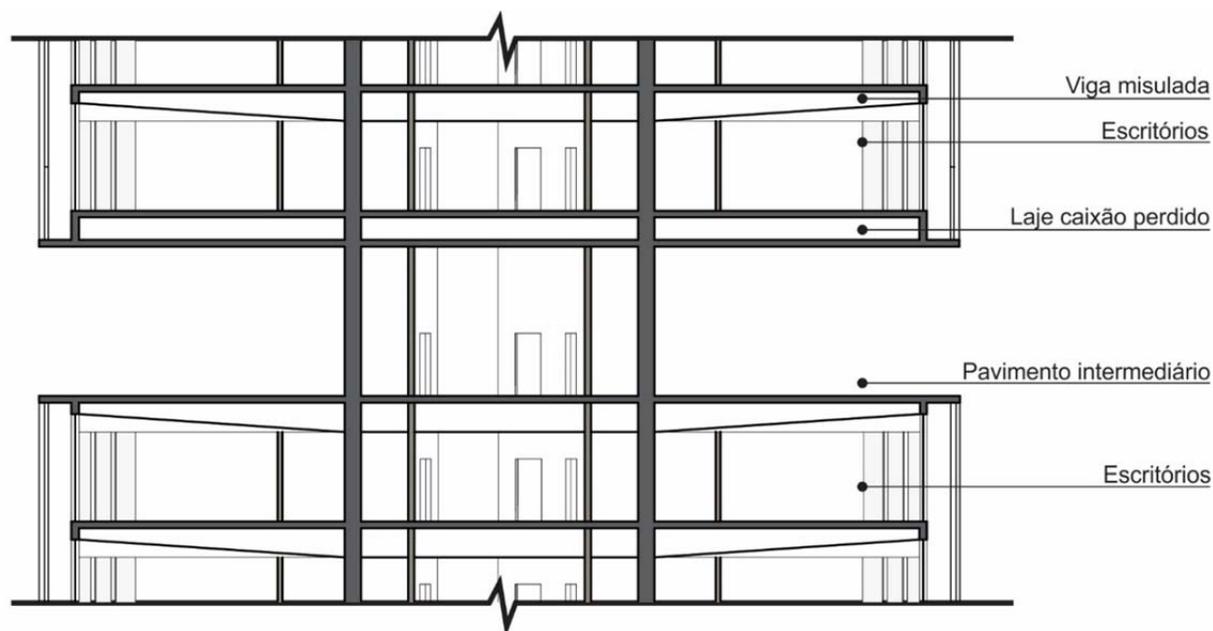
Corte estrutural passando pelo pavimento intermediário e laje caixão perdido
